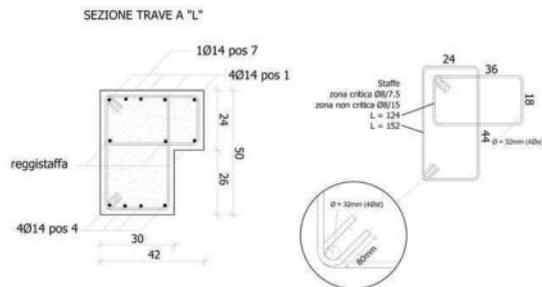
Particolare 1: sezione e staffe trave a L
